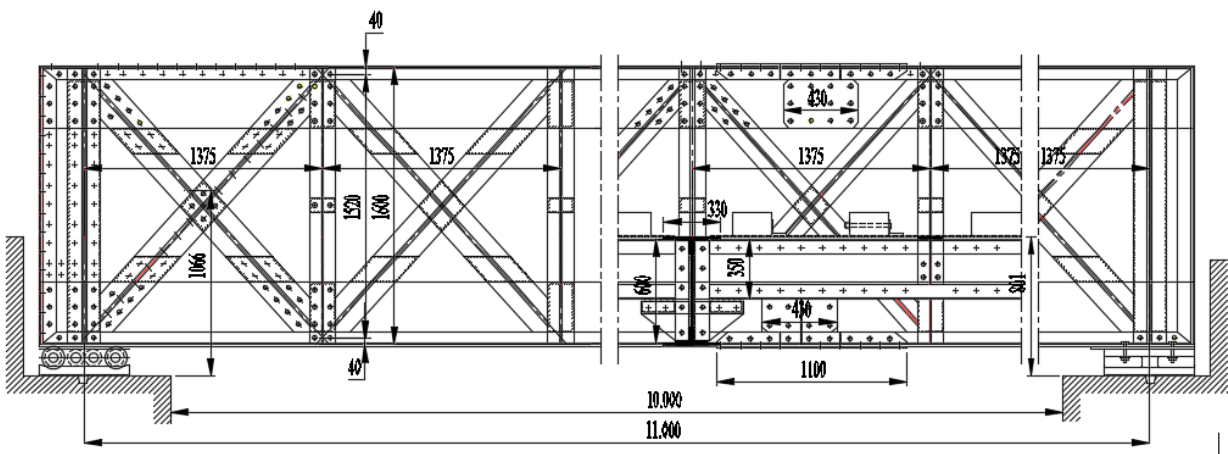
Vue en élévation de la poutre en treillis du pont PK 52+939
